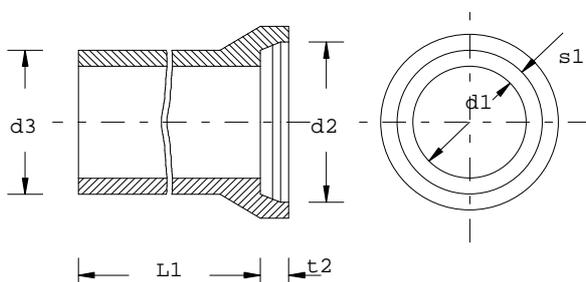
tubi in calcestruzzo di sezione circolare con manicotto senza piede
